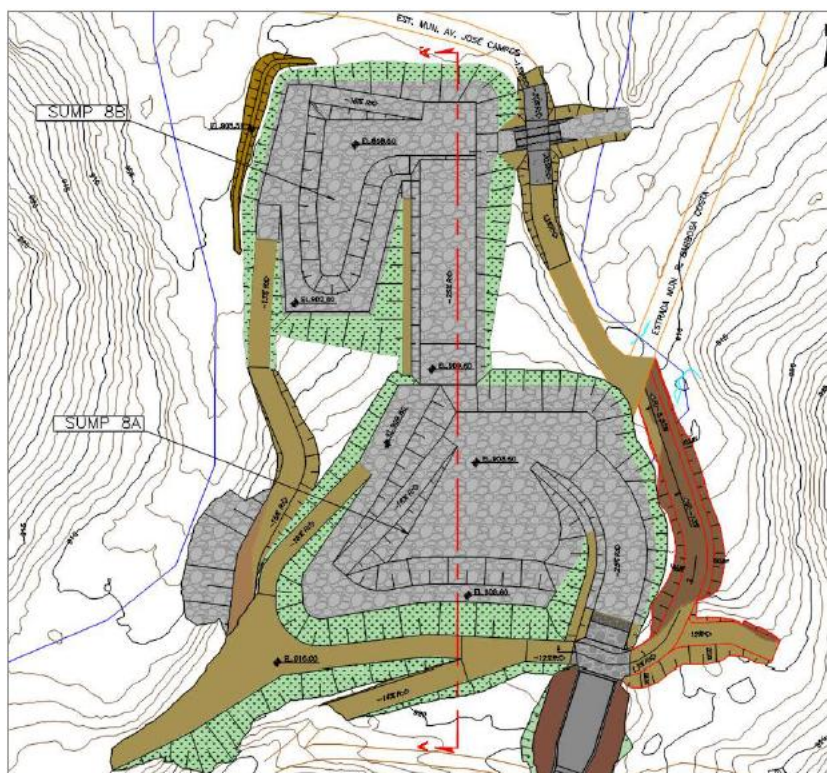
Sumps 8A e 8B – Arranjo Geral - Planta.
